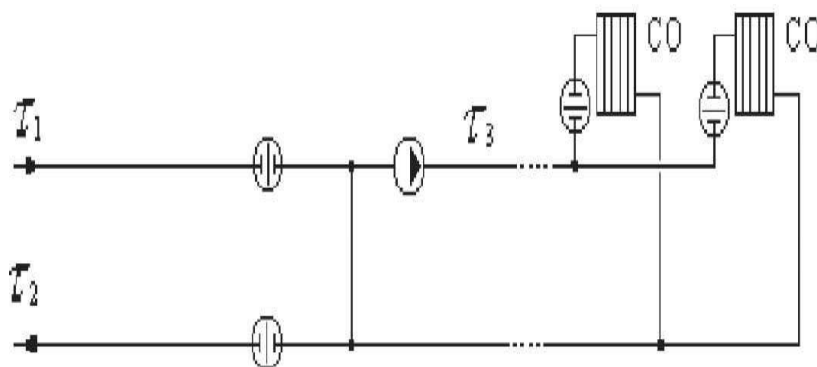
Схема ЦТП с насосом смешения на подающем трубопроводе
